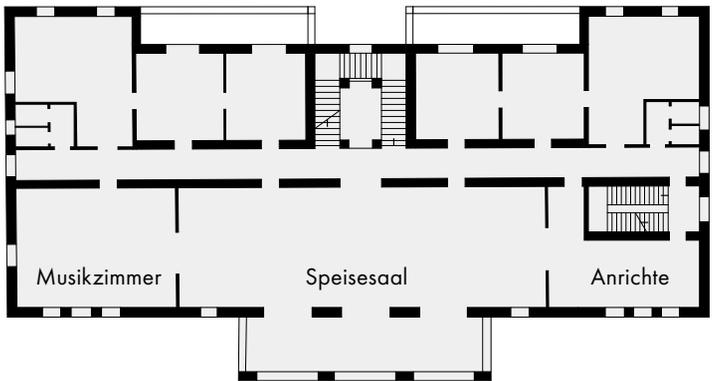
Grundriss 1. Obergeschoß.
